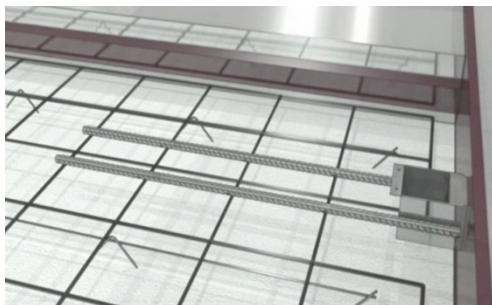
Colocación pies de pared, Ref. PEIKKO
